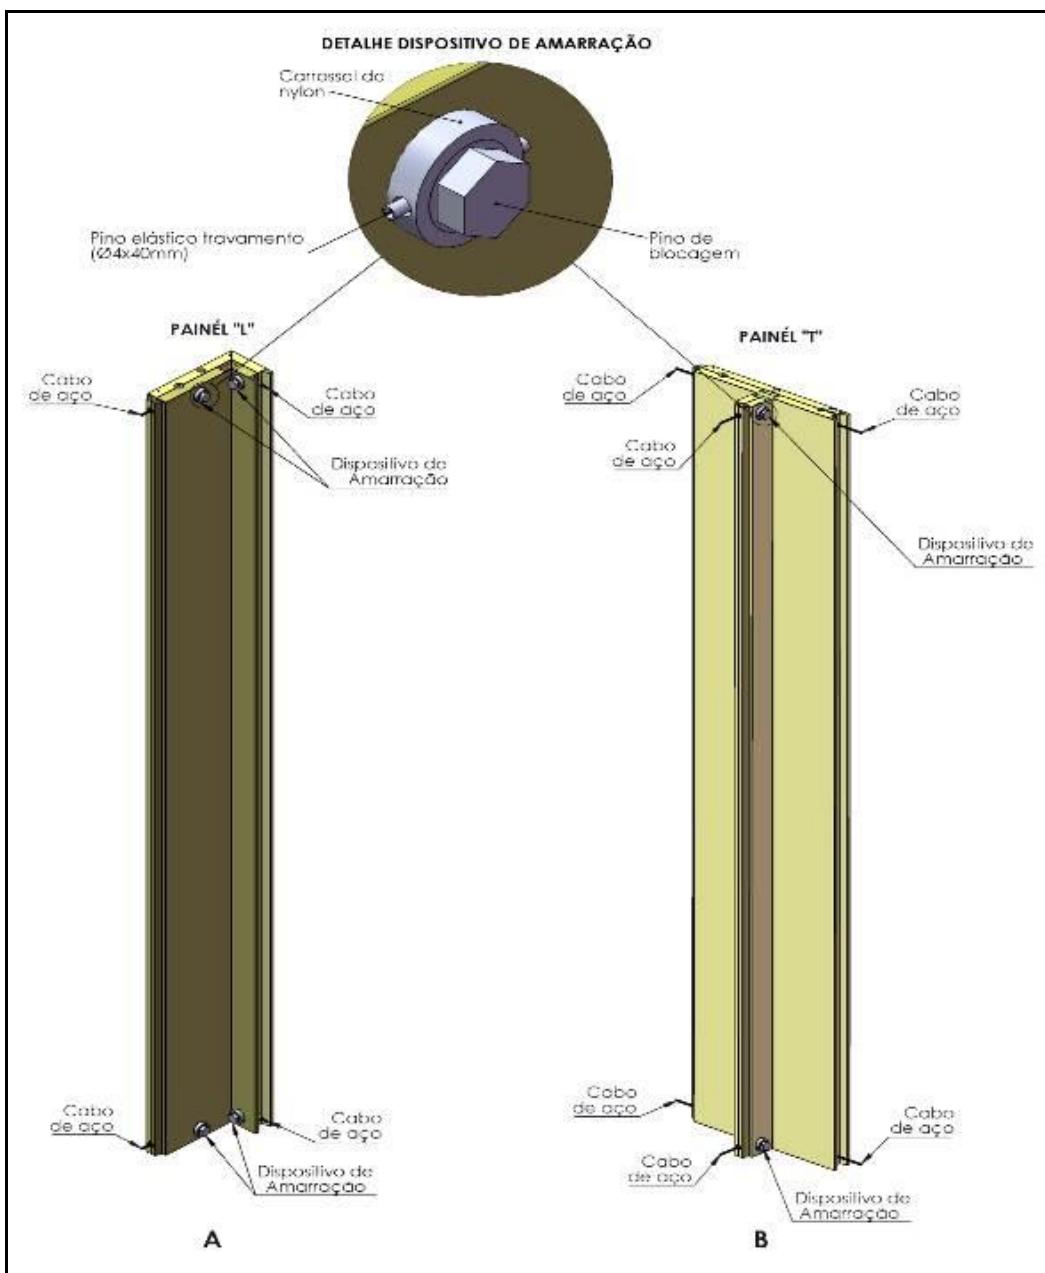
Dispositivo de amarração nos painéis “L” e “T”.
